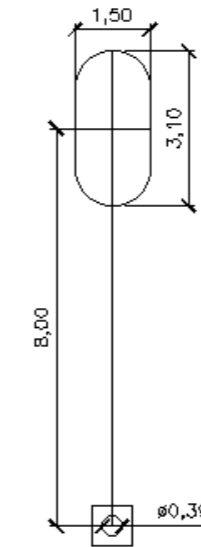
Vista en planta de una sección tubular de una torre con su correspondiente retenida. Fuente: Elaboración propia.
